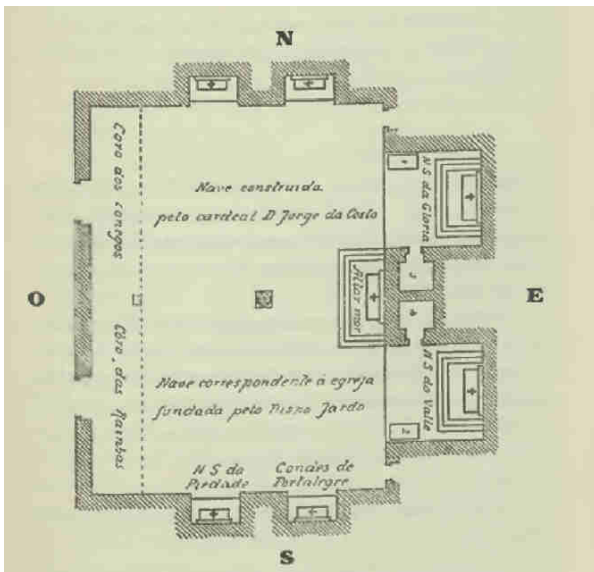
Planta da igreja após as obras de 1474, segundo reconstrução feita por Henrique Loureiro.
